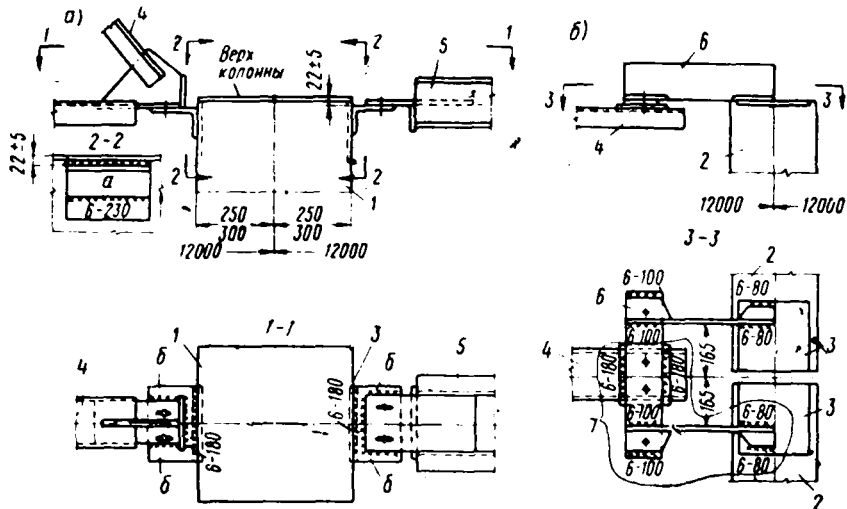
Детали крепления стальных вертикальных связей к колоннам и фермам по средним рядам зданий с плоской кровлей
